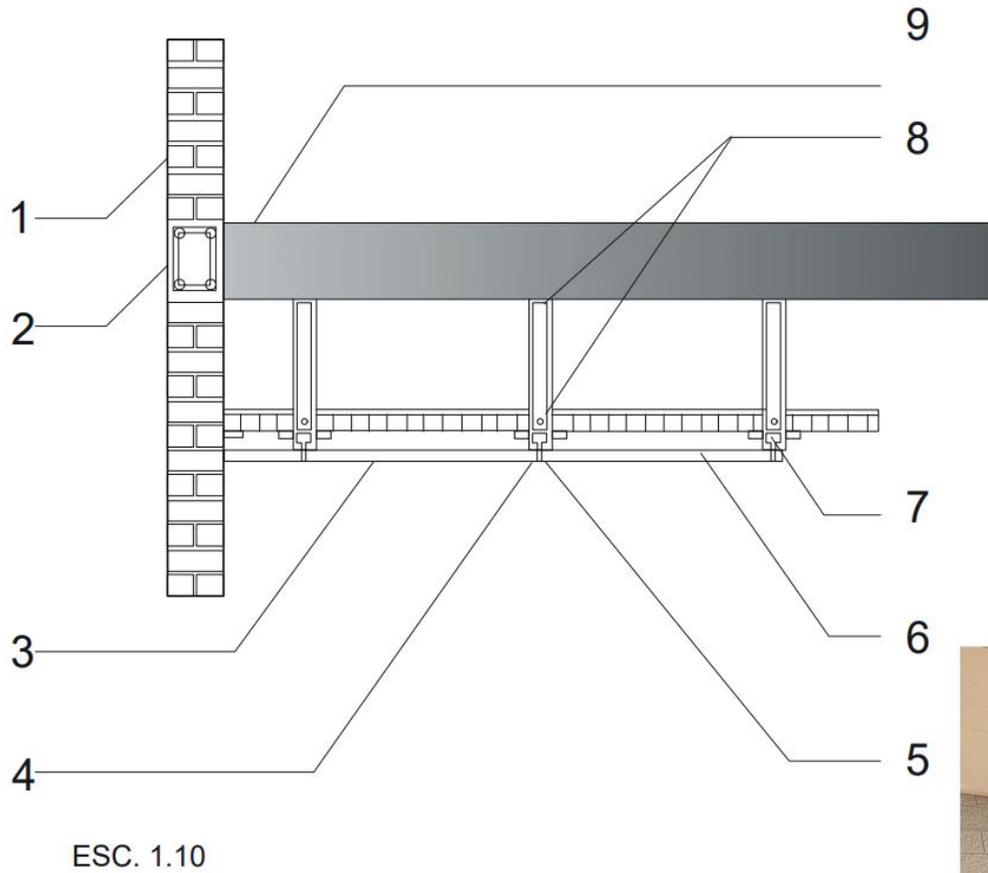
Detalles constructivos cielos rasos (lamina 1).
